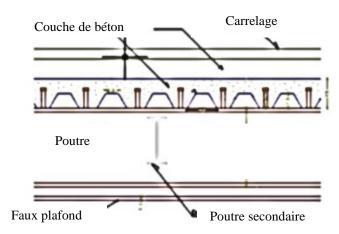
Plancher collaborant Source: Marc Landowski et Bertrand Lemoine « concevoir et construire en acier » © Arcelor, Luxembourg, 2005
